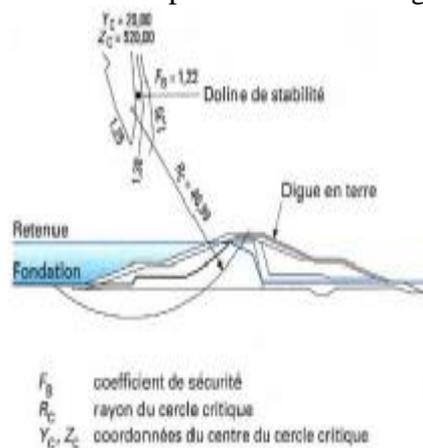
Epure de stabilité d'un remblai (technique de l'ingénieur)
